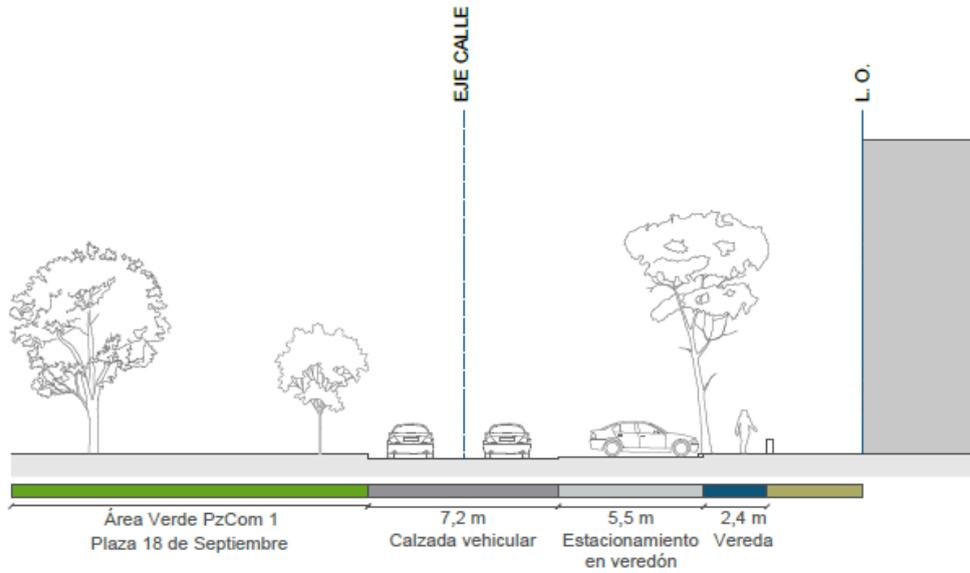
Perfil D-D'. Situación existente plaza 18 de Septiembre.
